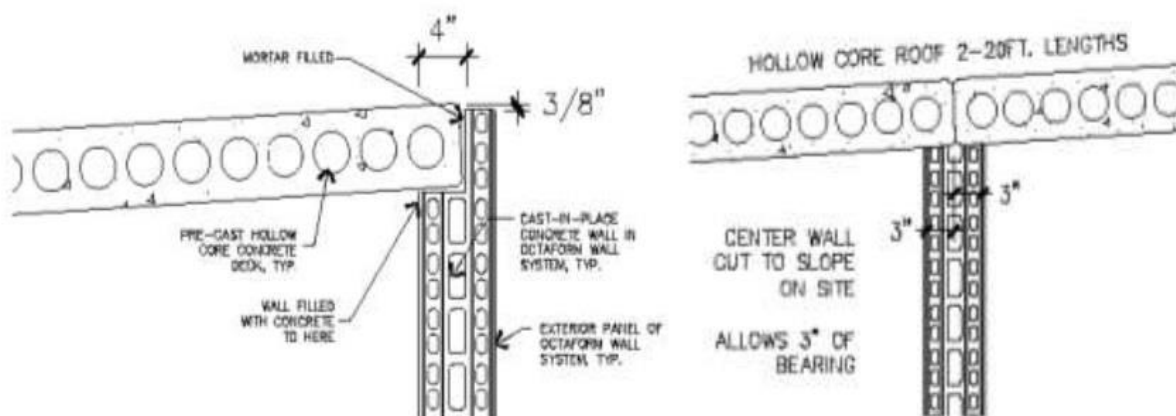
Detalhe da ligação da parede com laje pré-fabricada
